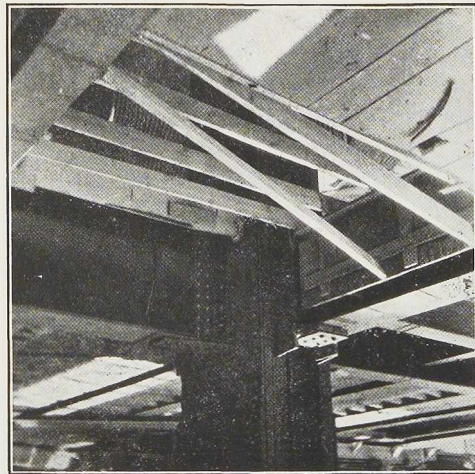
Suspension des coffrages au poutrelage métallique, supprimant tout étaçonnage. A noter le système de l'armature soudée accrochée à l'aile inférieure des maîtresses-poutres pour le maintien du béton d'enrobage.
